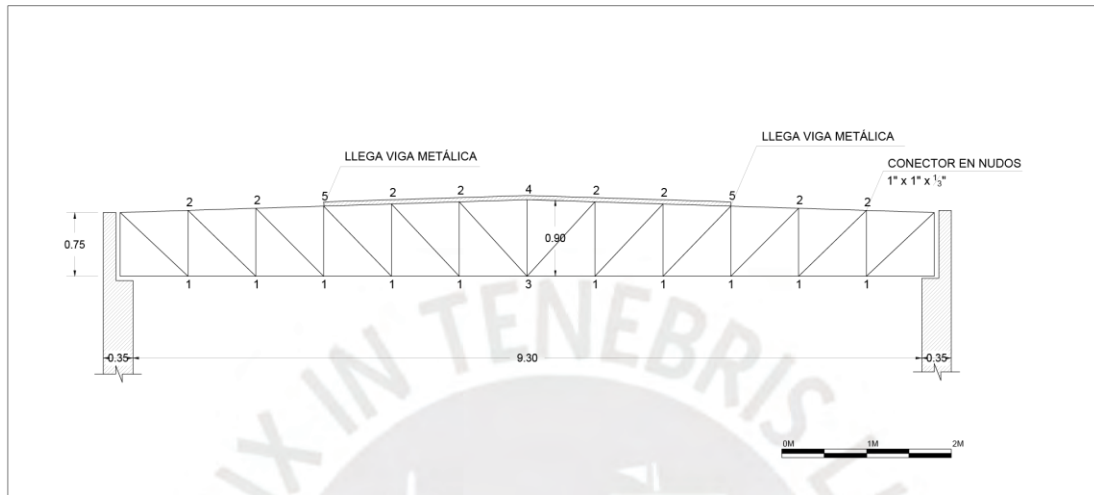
Elevación de armadura de techo de Espacio Danza. Elaboración propia basada en fotografías propias de planos de detalles de Espacio Danza. Año 2022. Fuente: propia.
